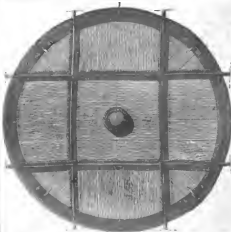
Pianta d'una piattaforma girevole circolare con binari rettangolari.
